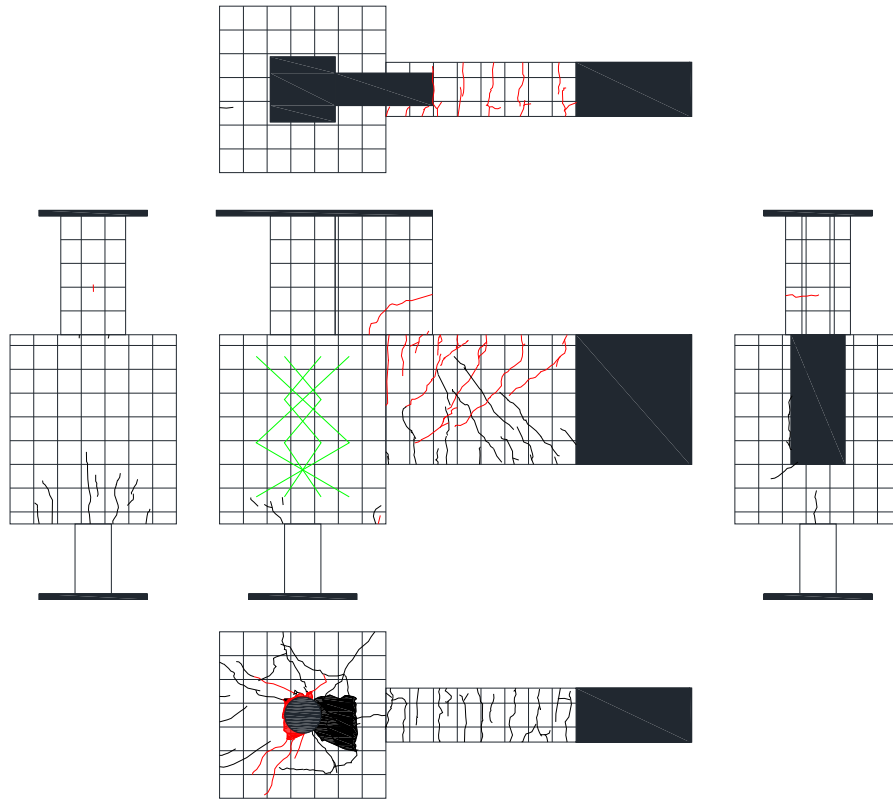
試験体 DR-1 ひび割れ状況 (7Cycle)
